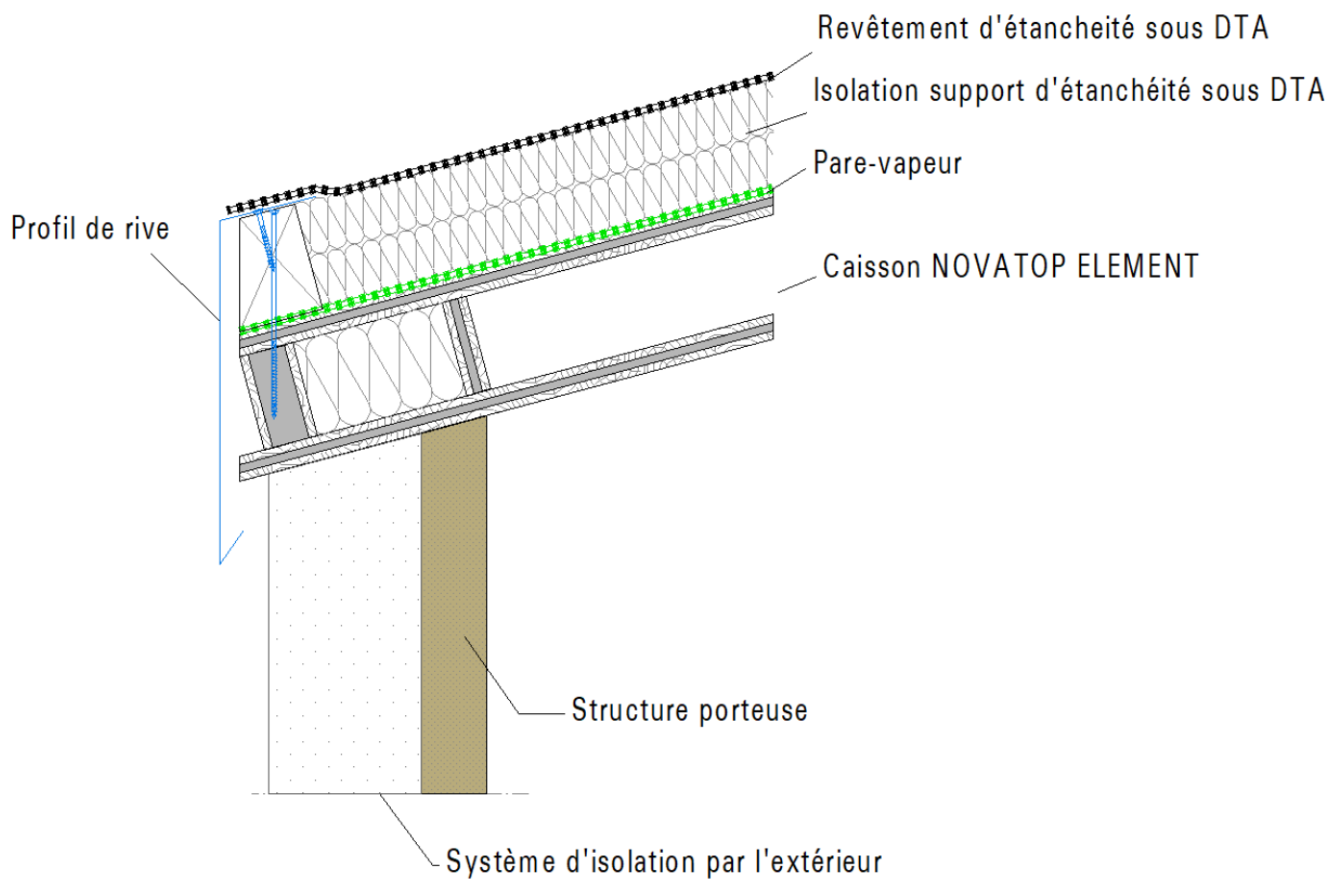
A2 – Rive de revêtement d'étanchéité autoprotégé monocouche
